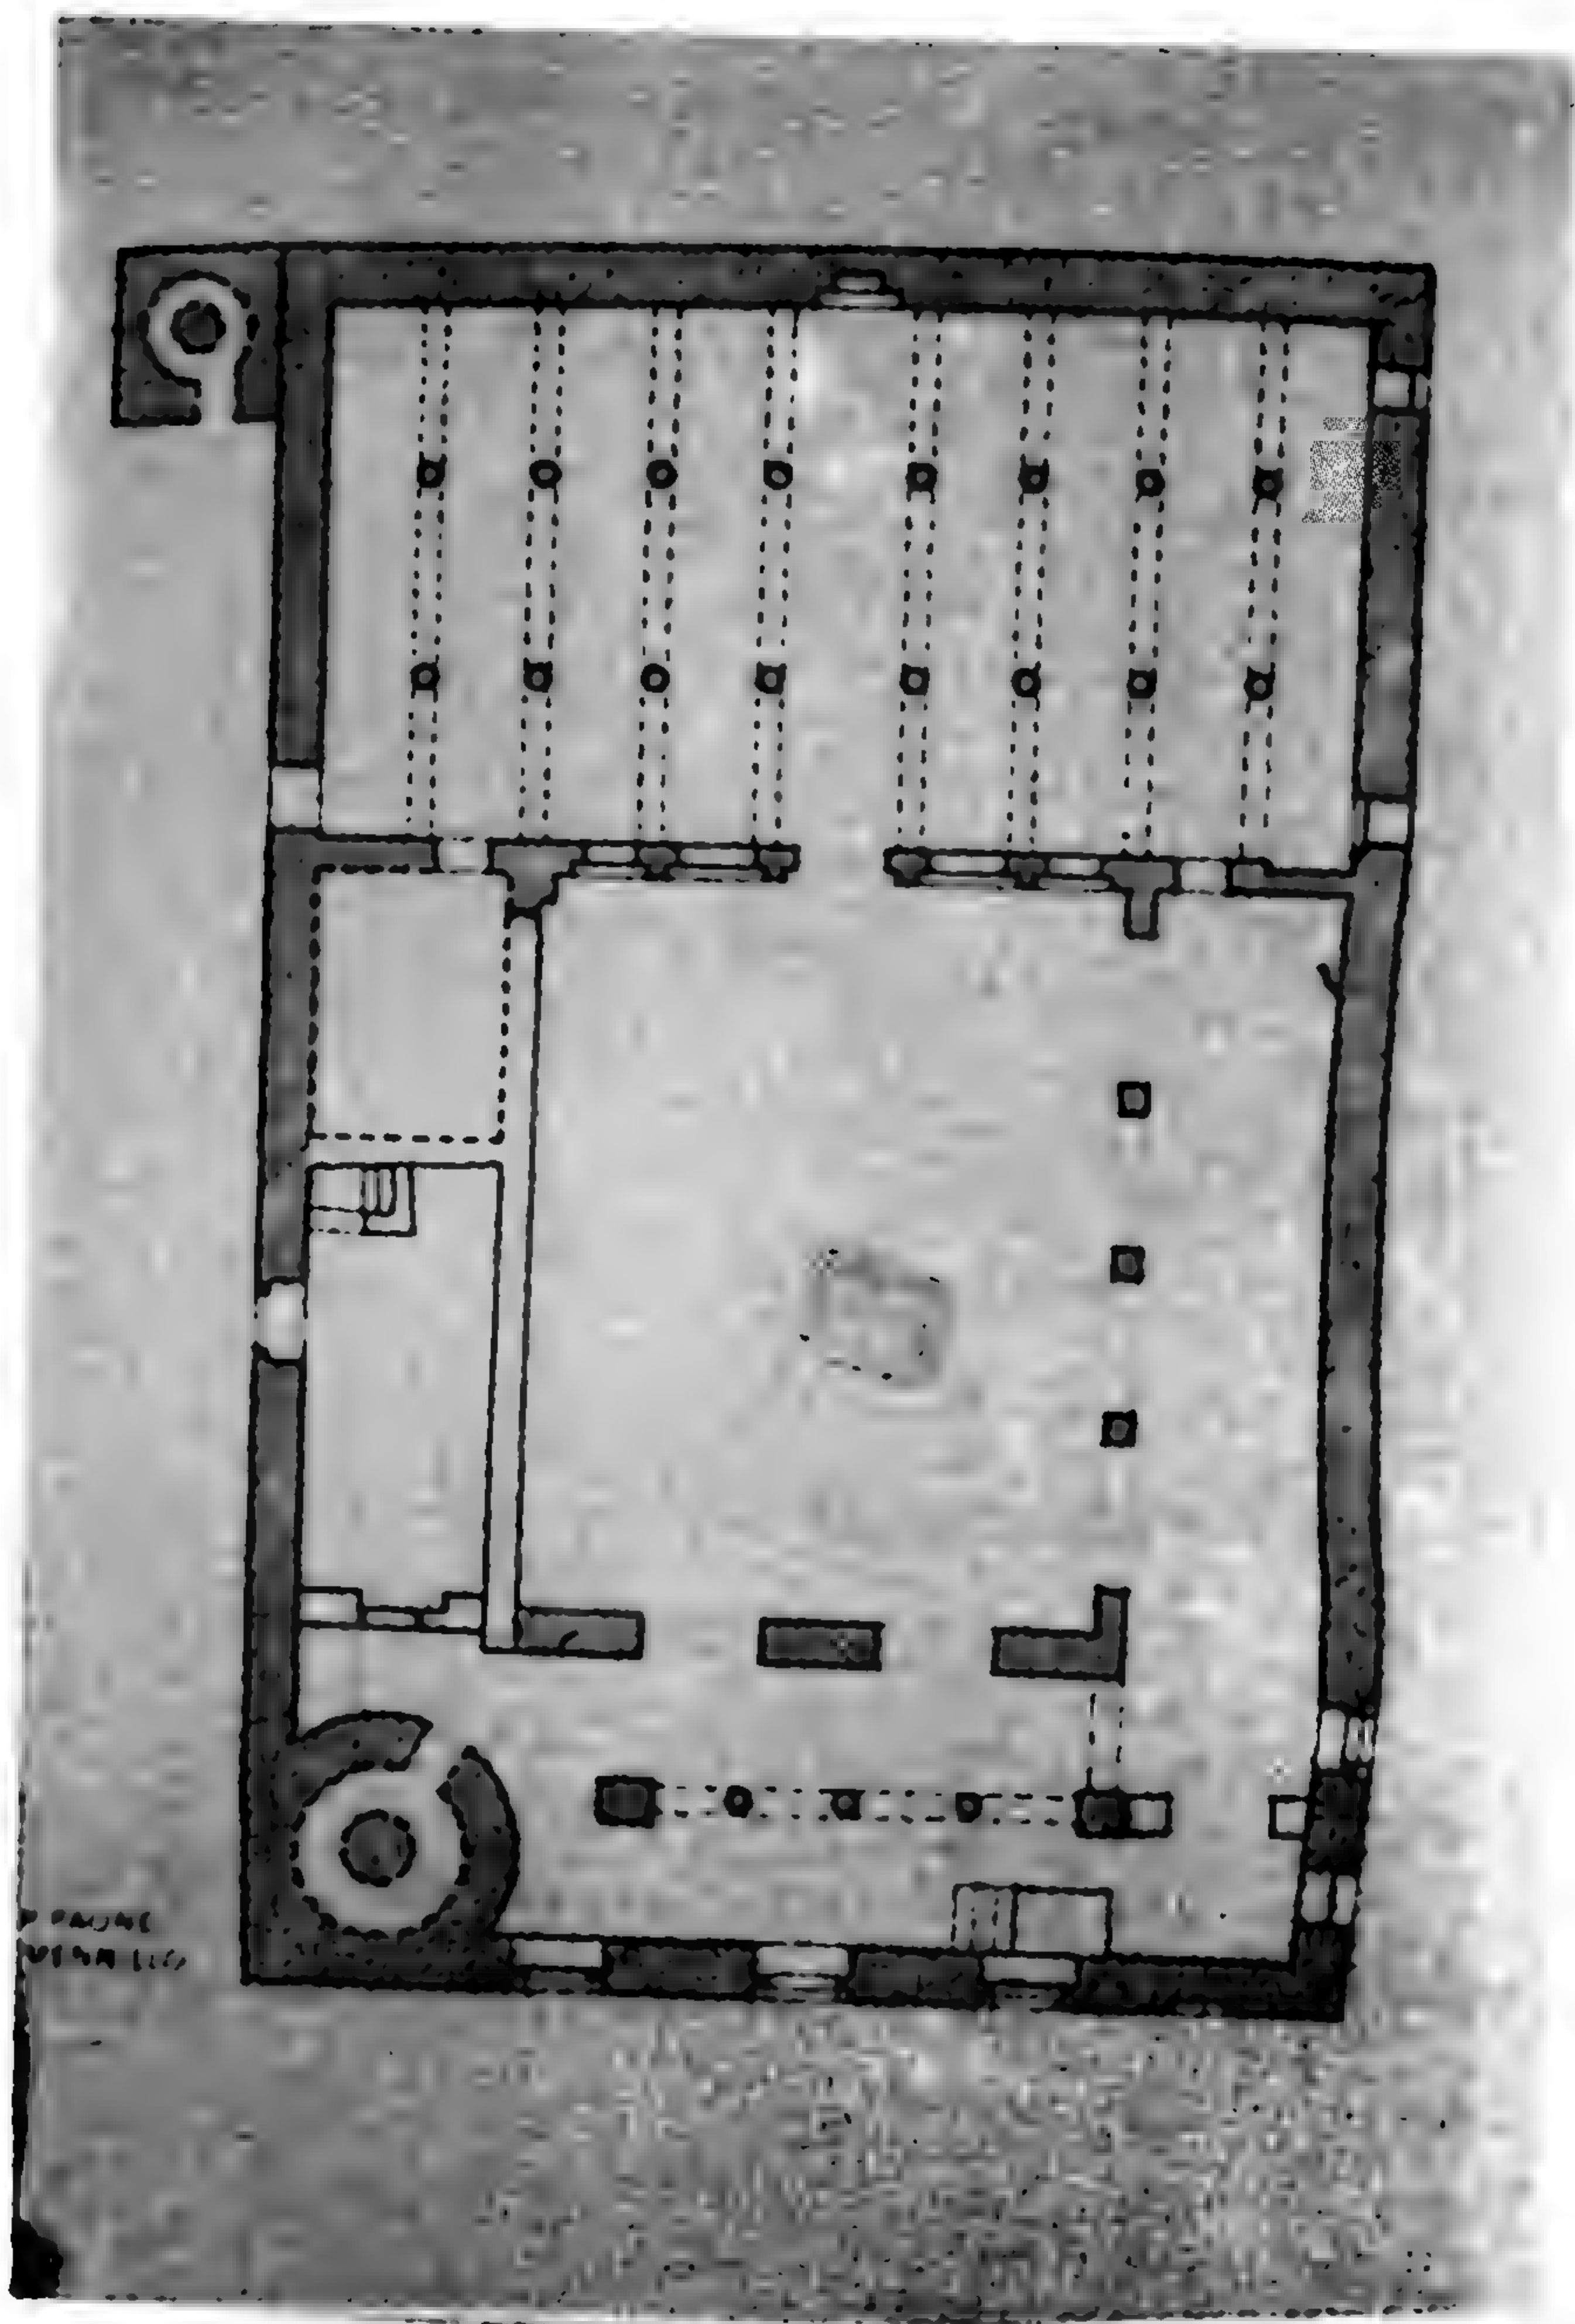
المسقط الأفقي للجامع الكبير بدمار (كروكي مبدئي)
